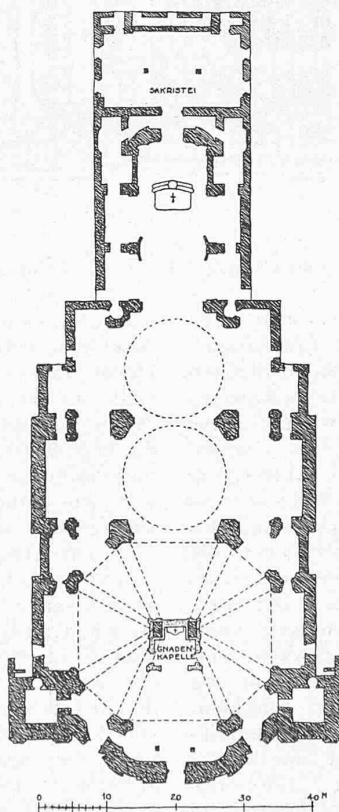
Einsiedeln, Grundriss 1:1000.
